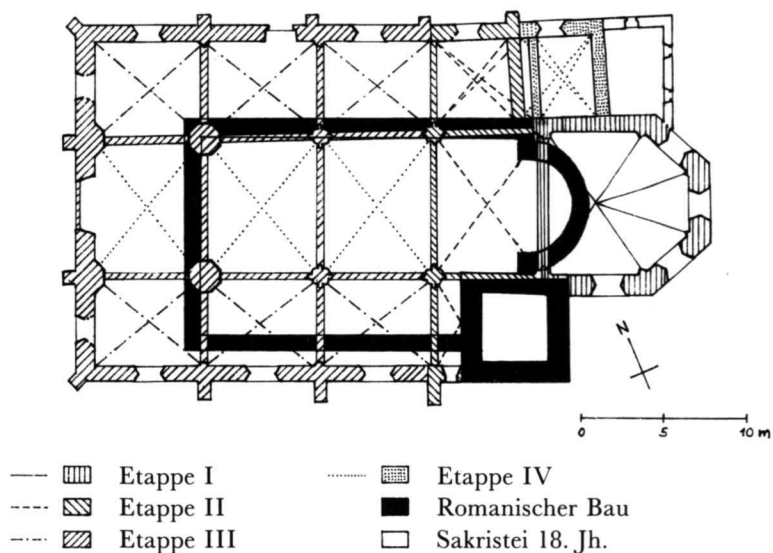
Grundriss mit schematischem Etappenplan.
